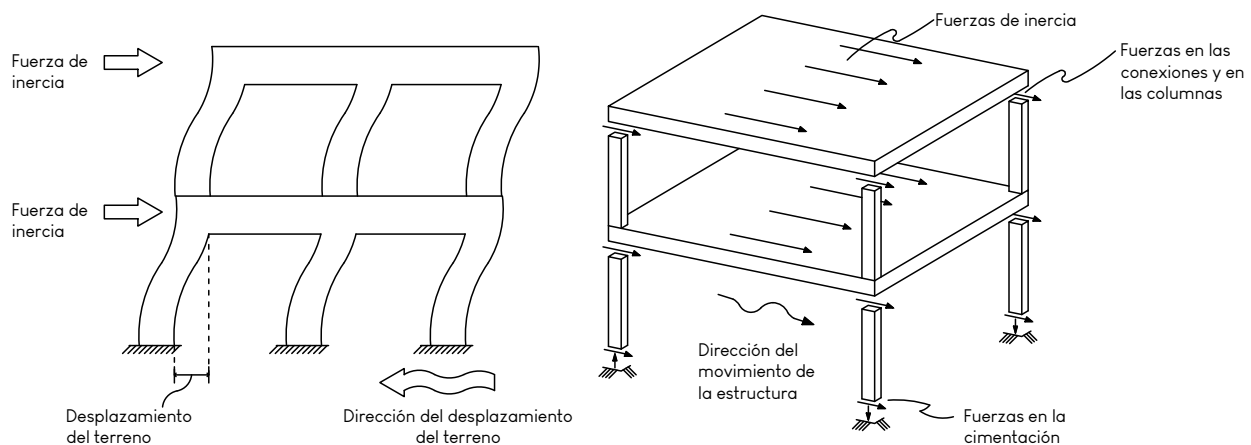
Esquema que muestra como actúan las fuerzas de inercia generadas por la vibración de la estructura ante un sismo. Fuente adaptada de Bazán y Meli, 2006, p.29.
